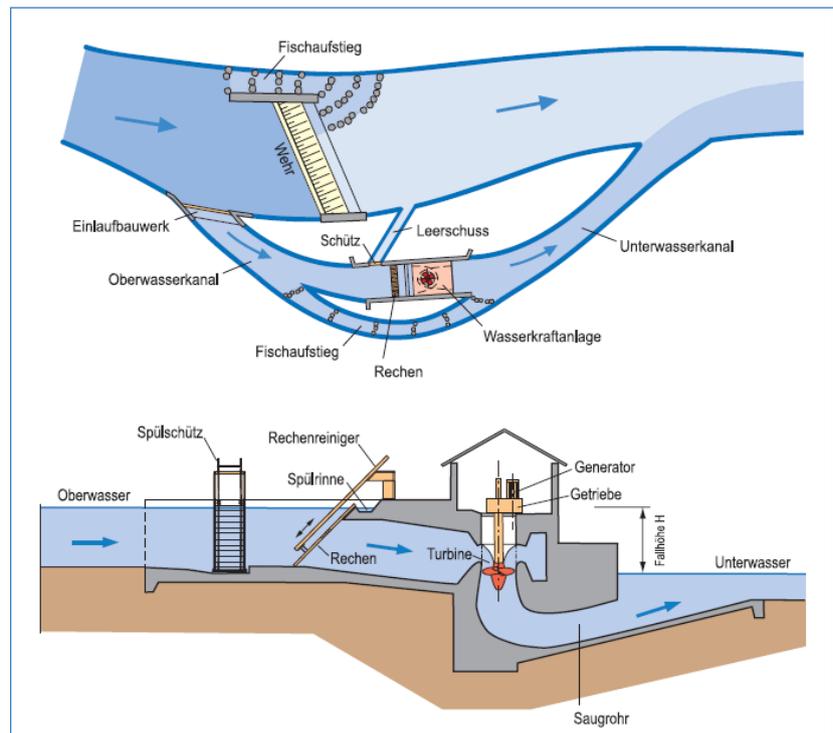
Bauteile einer Wasserkraftanlage [3]
